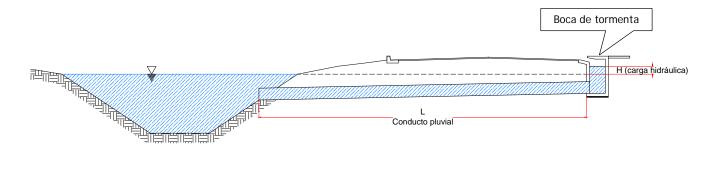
Conducto con entrada y salida sumergidas
